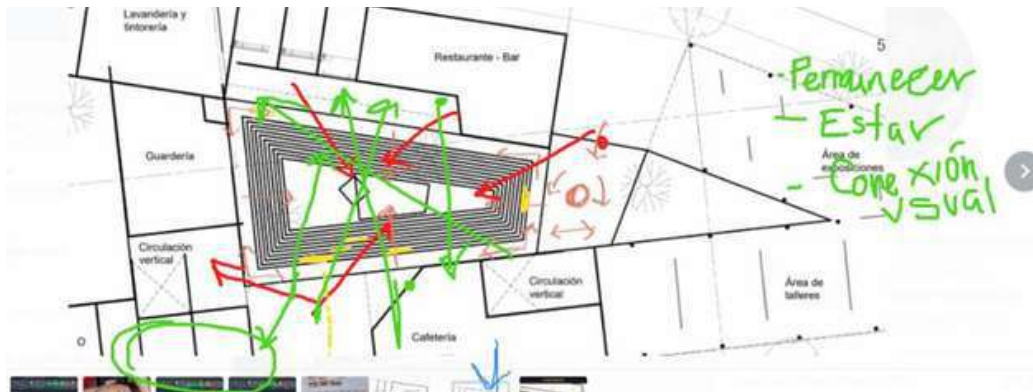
Exploración de visuales interior/externo. Fuente: Autoría propia
